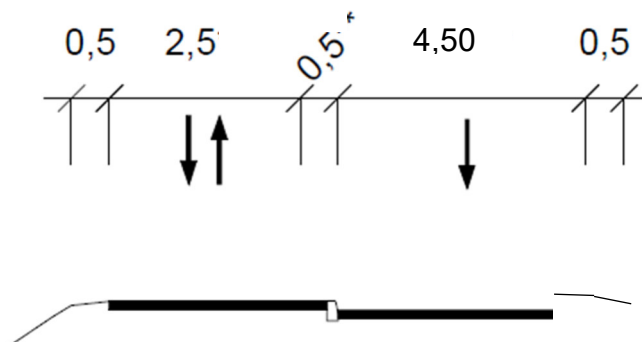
geplanter Querschnitt Rampe West, AS Dalheim
